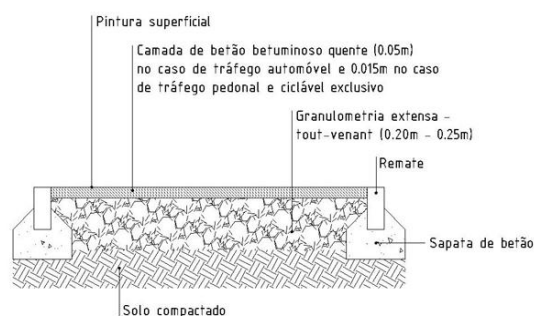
Pormenor tipo de pavimento da ciclovía em betão betuminoso [76].
